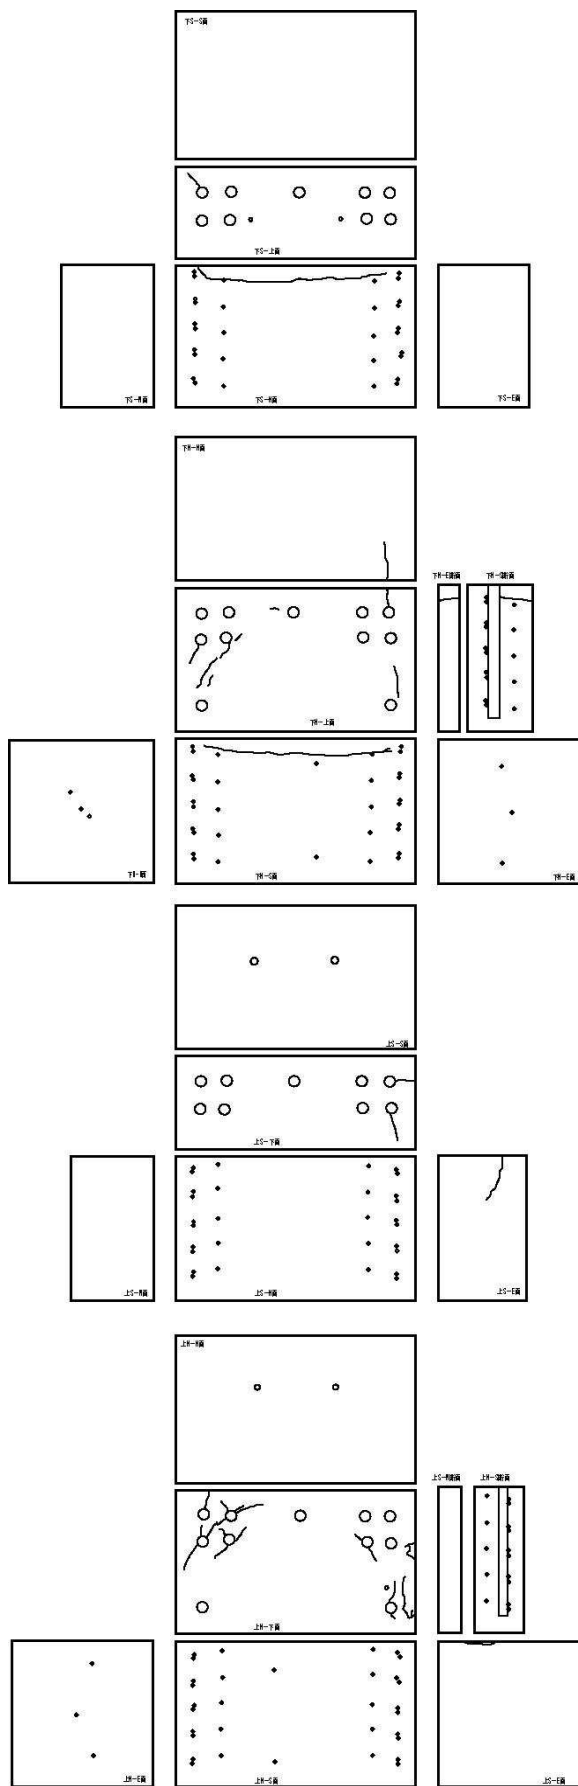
EXSR-1 日脱型のひび割れ図
